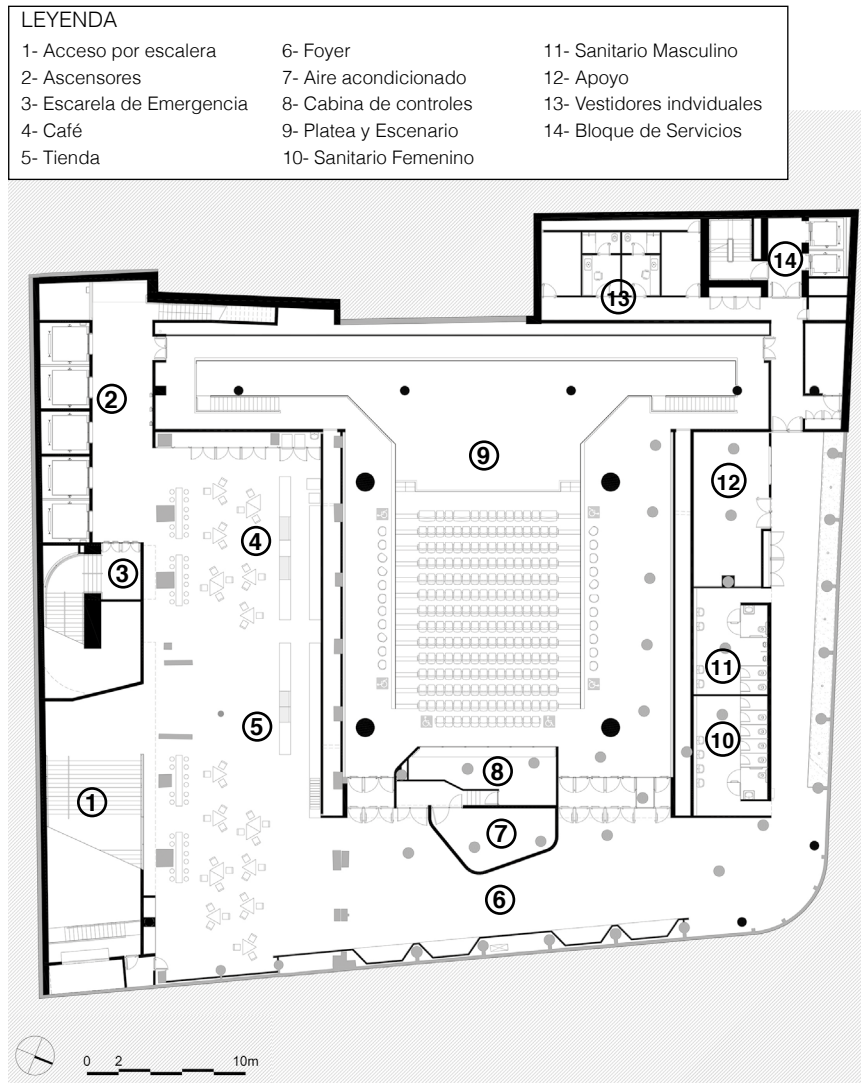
Planta Sótano -1 del Sesc 24 de Maio. (Autoría propia. 2021. Base: MMBB Arquitectos).
